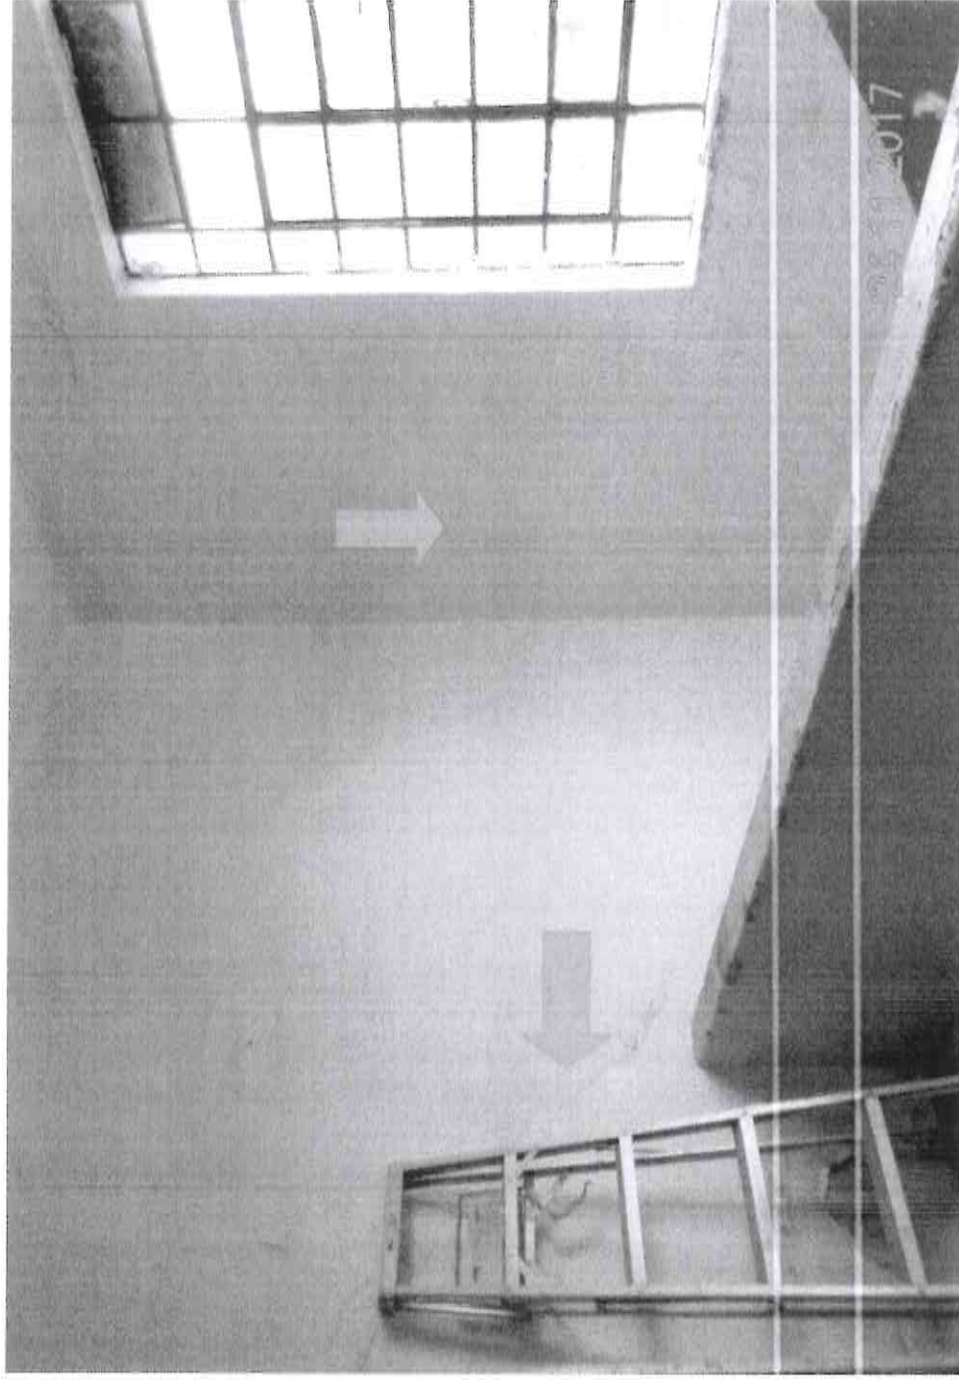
Agrietamiento del muro perimetral de la BM-8 que da a uno de los patios de maniobras, sin rotura de piezas de mampostería.
